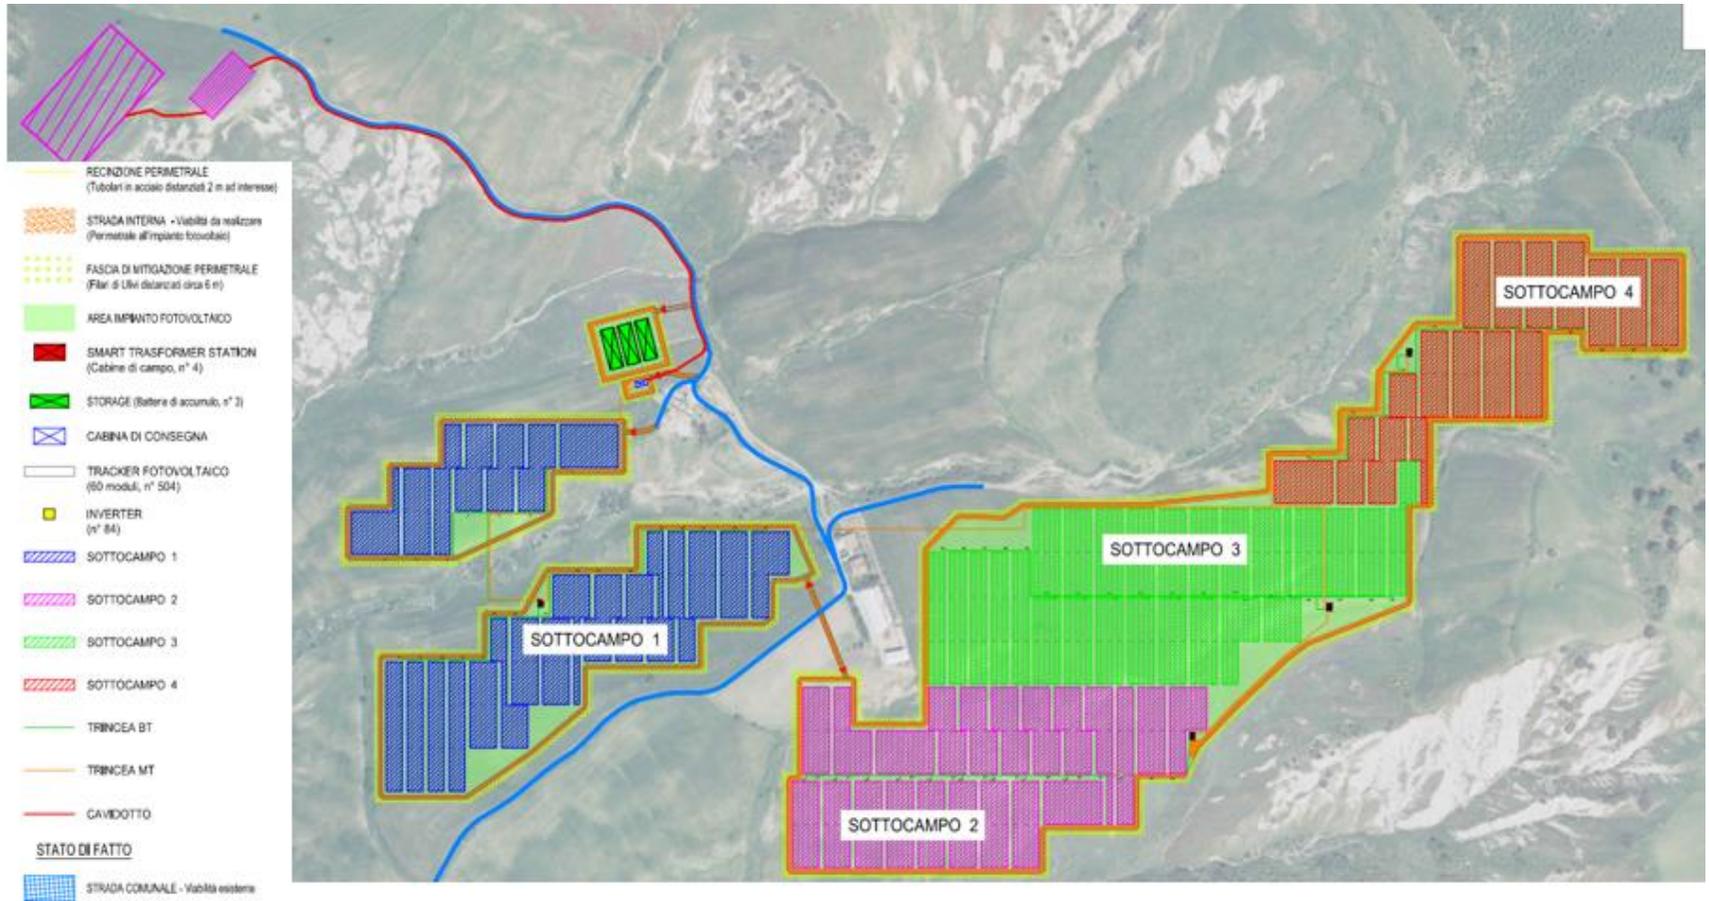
Stralcio planimetrico con indicazione dei sottocampi
